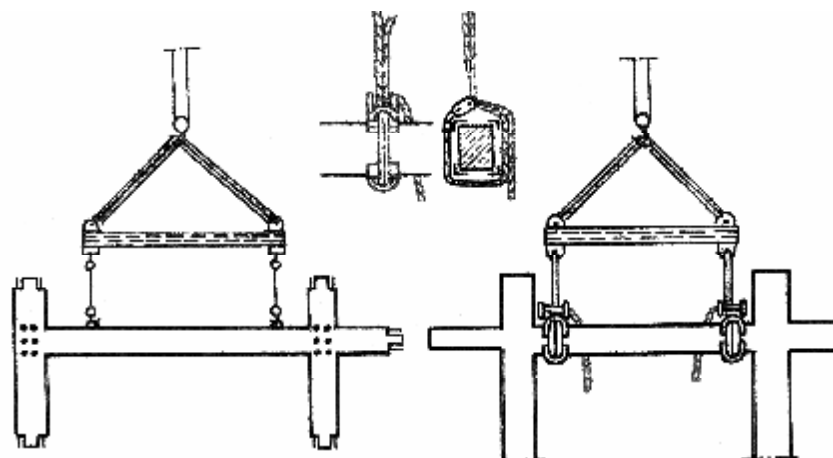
Схема стропування залізобетонних рам каркаса за петлі і в обхват напівавтоматичним стропом
